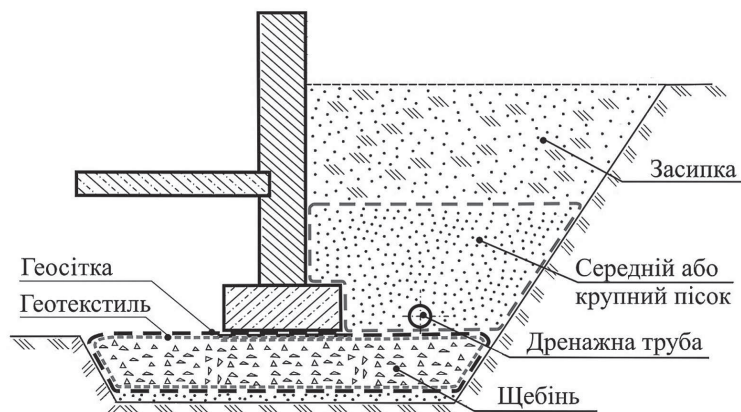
Конструкція прямокутного стрічкового фундаменту з геормованою фундаментною подушкою
